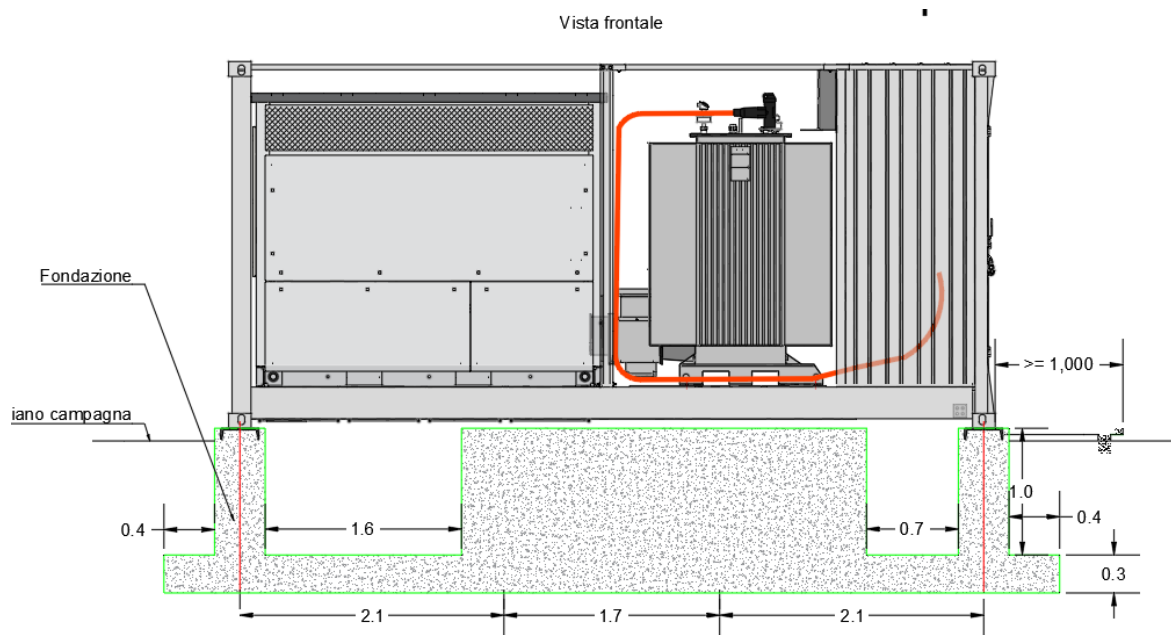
Vista frontale PS di progetto con fondazione in calcestruzzo armato
